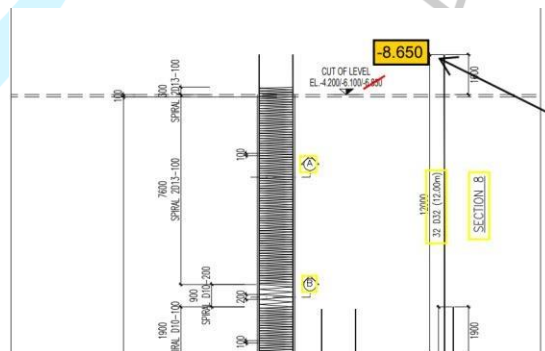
46 Shop drawing detail tulangan bored pile type G section 7
